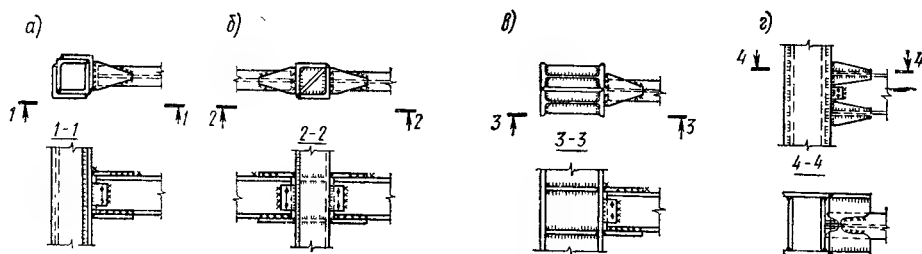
Рамные (жесткие) узлы крепления балок к колоннам замкнутого сечения
